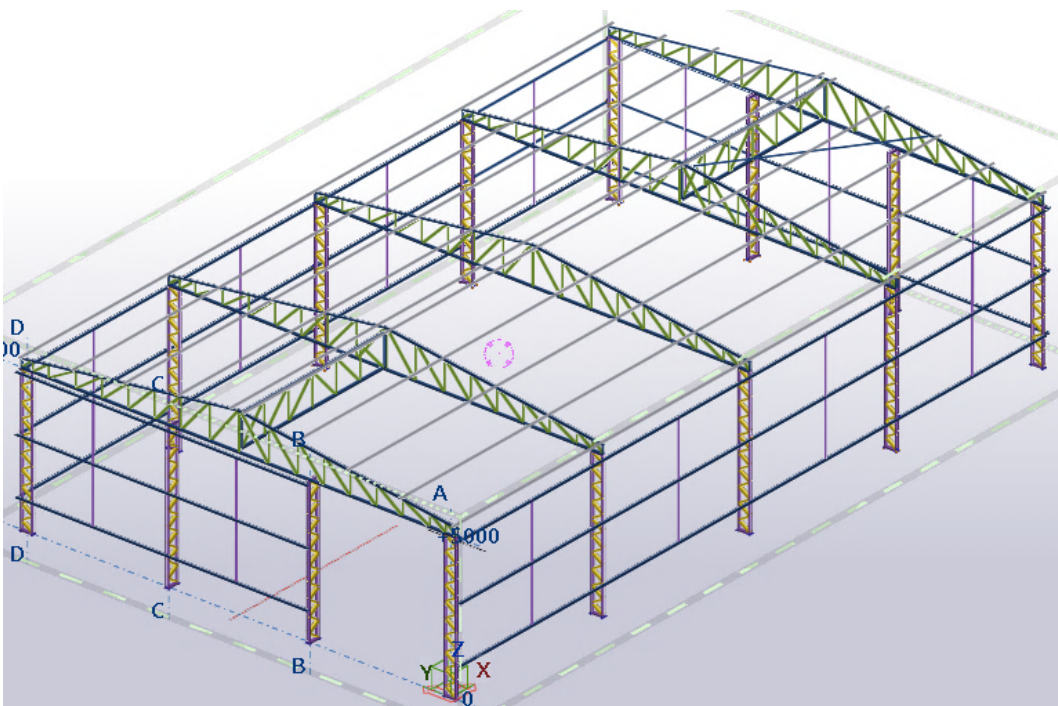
Madre de cobertura e fachada da nave industrial no Tekla Structures 2019i
